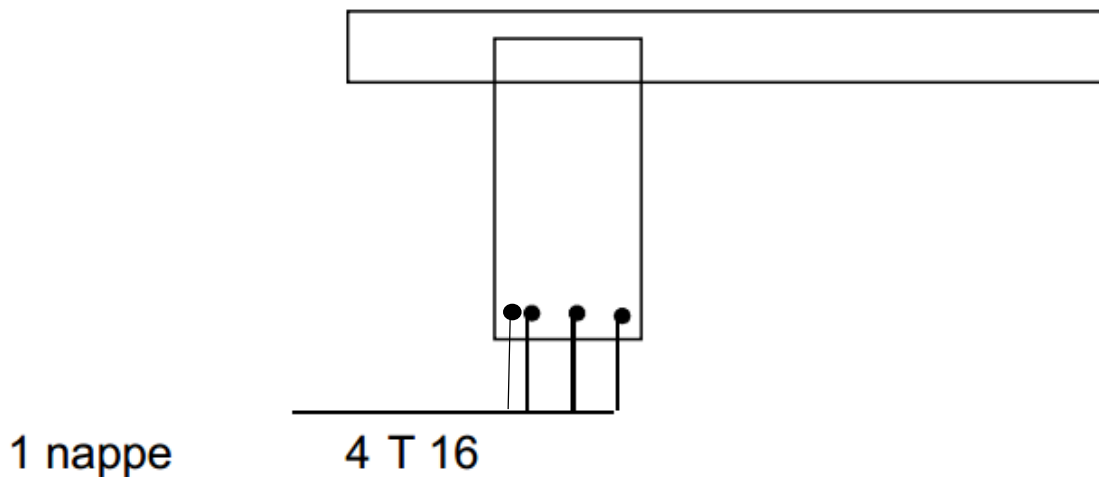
ferrailage de l'entretoise (nappe inf).
